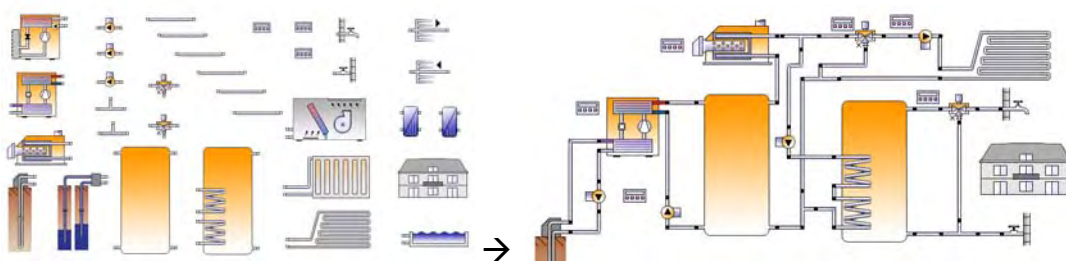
Modularer Aufbau der Komponente mit dem Polysun Designer
